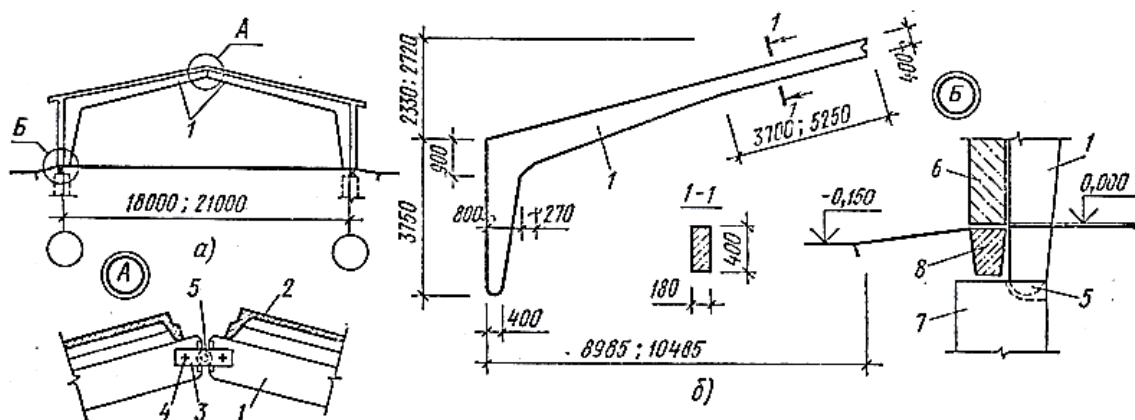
Железобетонные рамы для однопролетных зданий:
